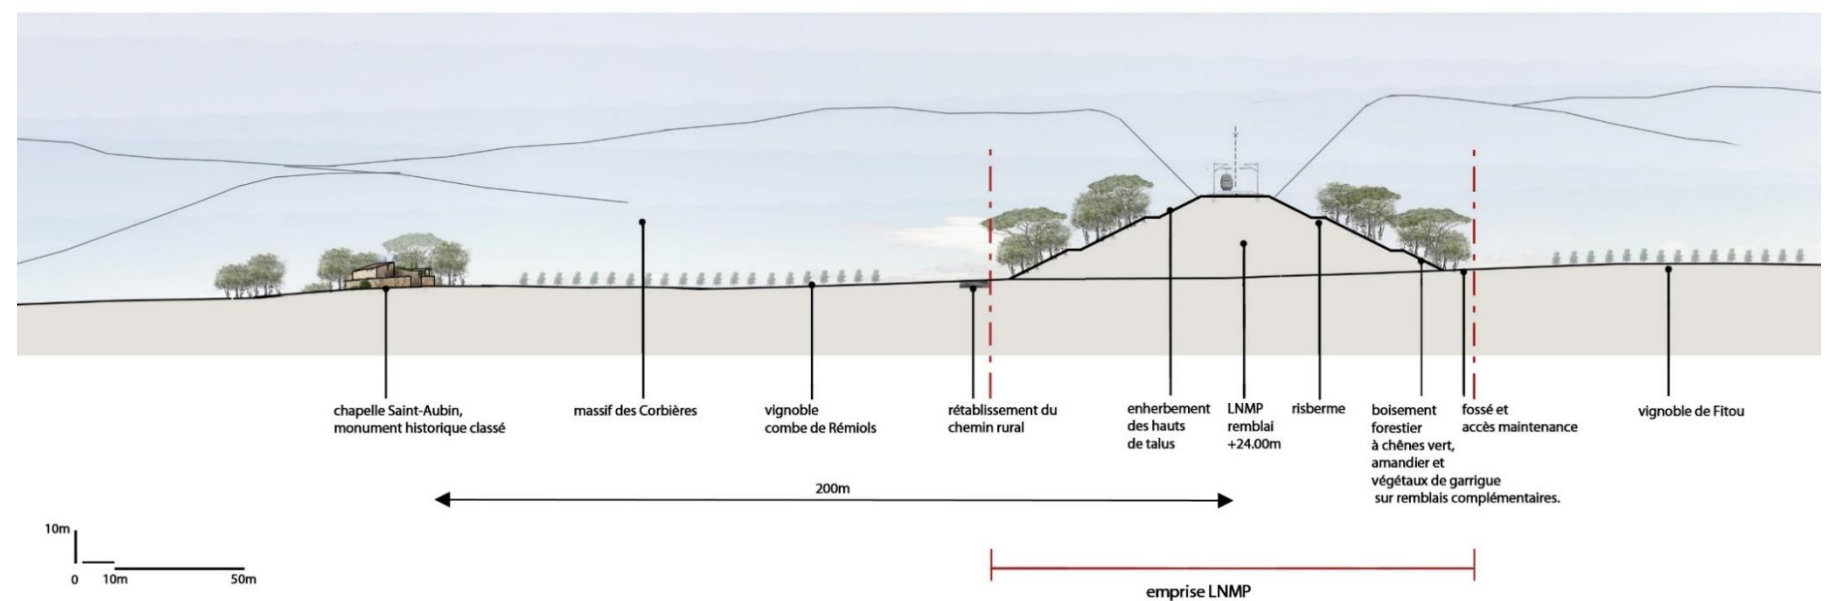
profil en travers au droit de la chapelle Saint-Aubin (source : Traverses)
